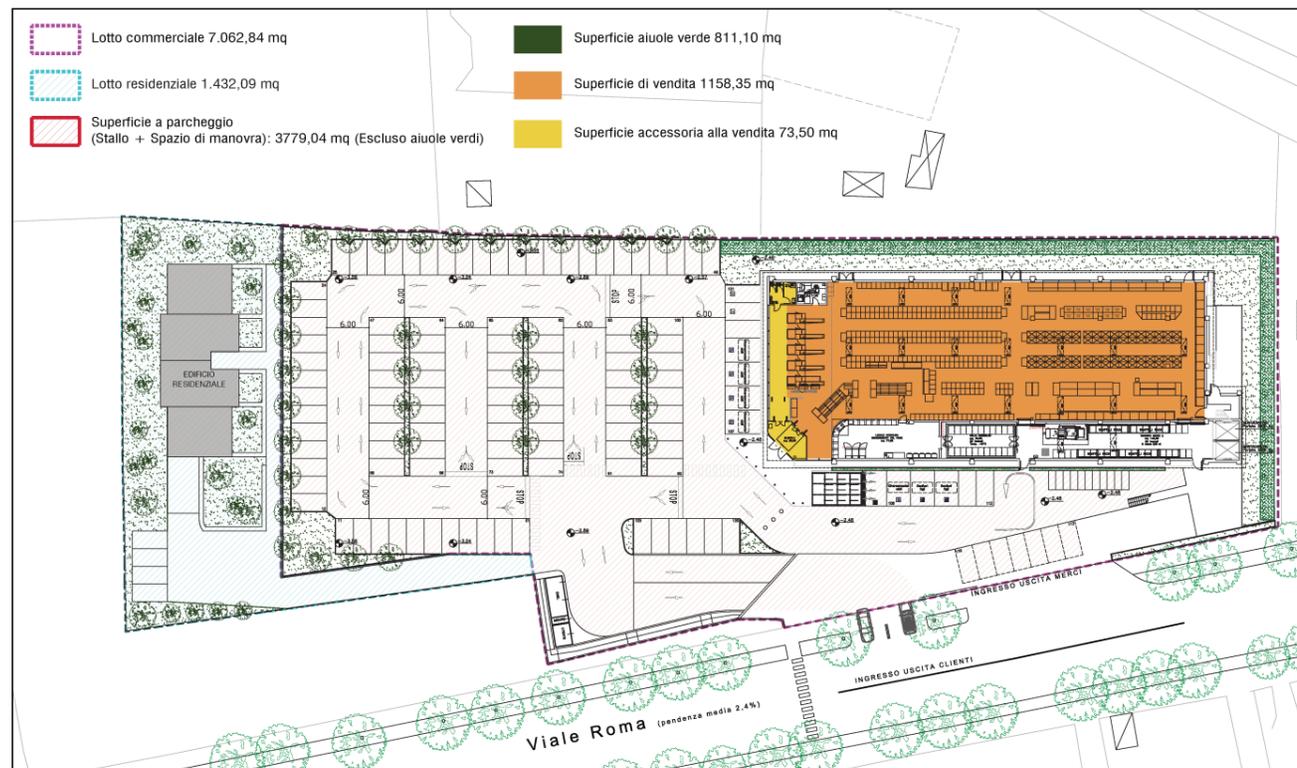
Planimetria indicativa del Piano Attuativo - Lotto Commerciale
